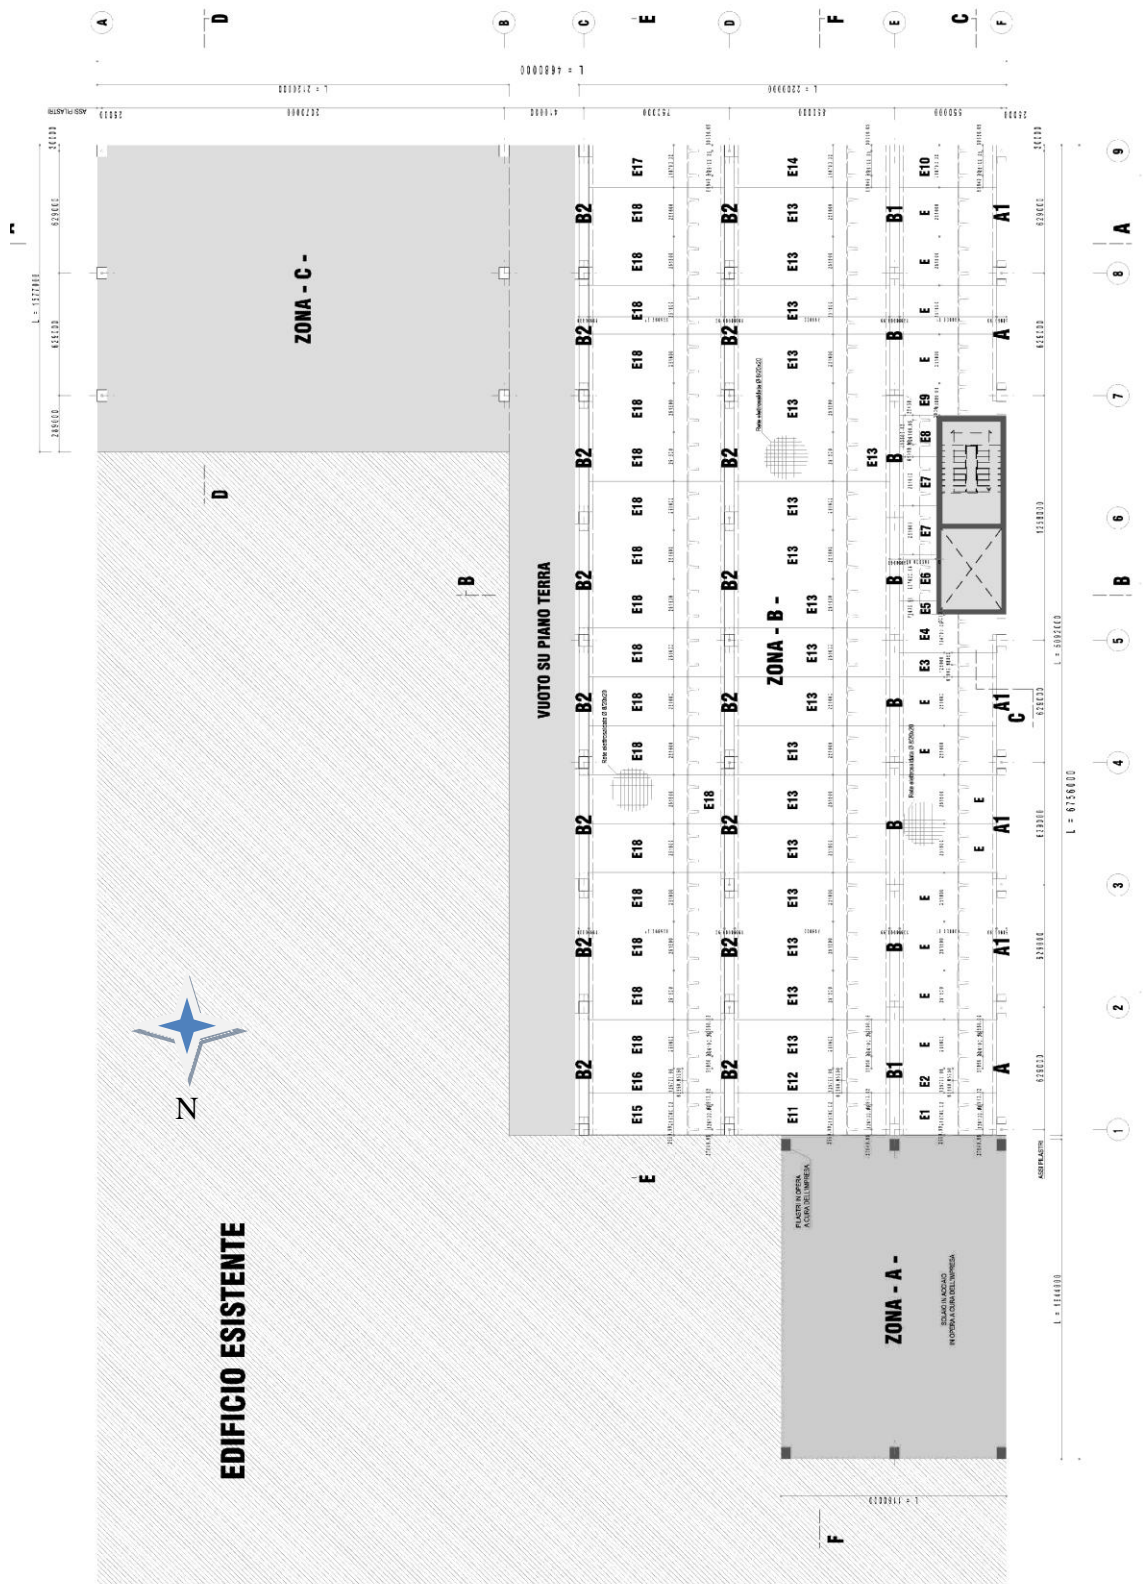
Particolare di A.2003.cap.us.T18 - Pianta piano primo
